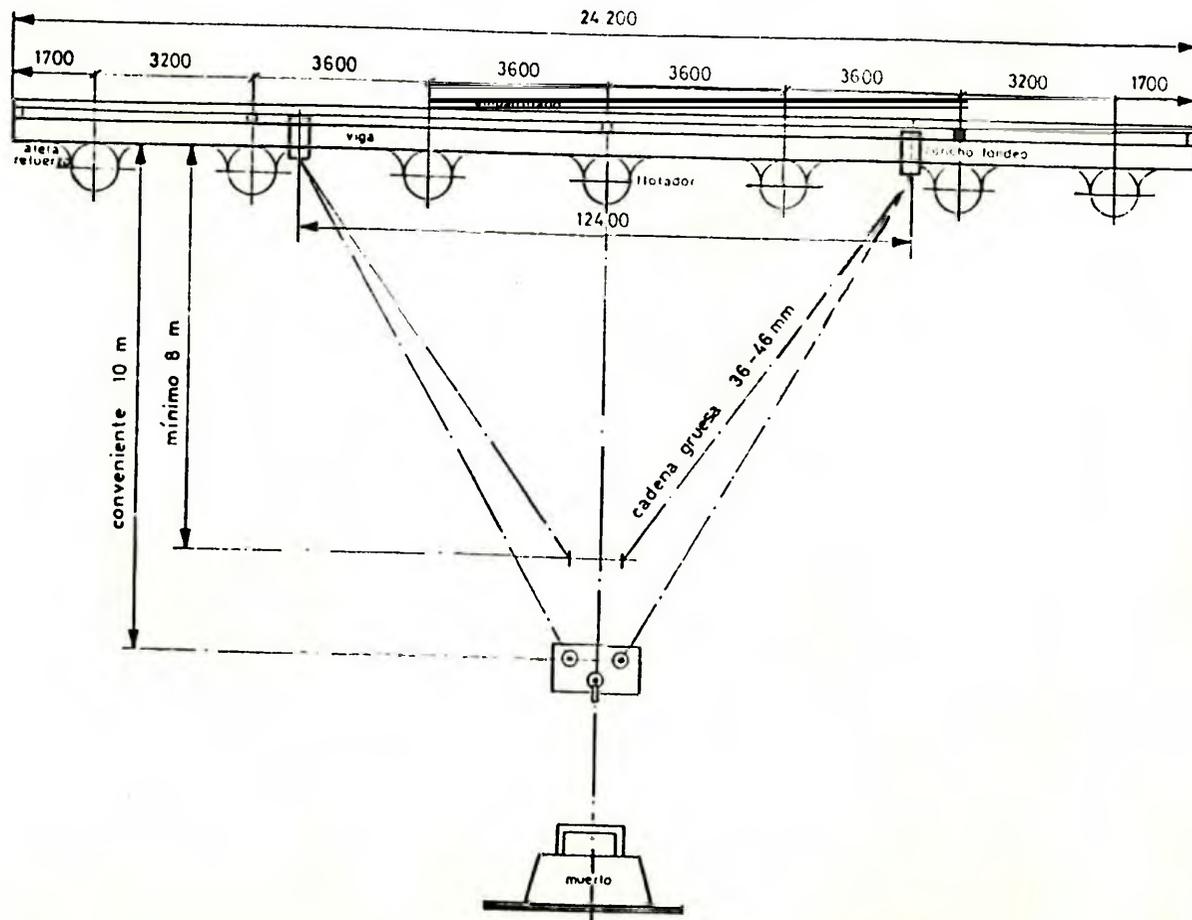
Batea de resina reforzada con fibra de vidrio, corte transversal.
